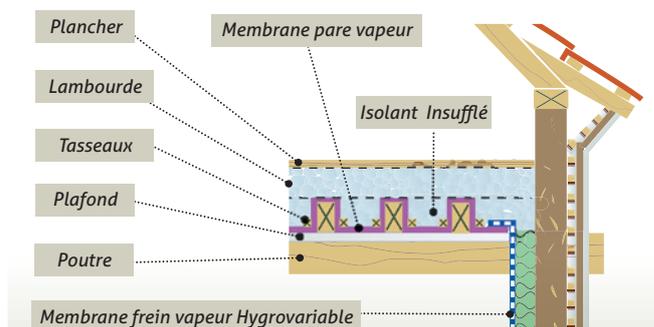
pare-vapeur posé par le dessus du plafond existant
